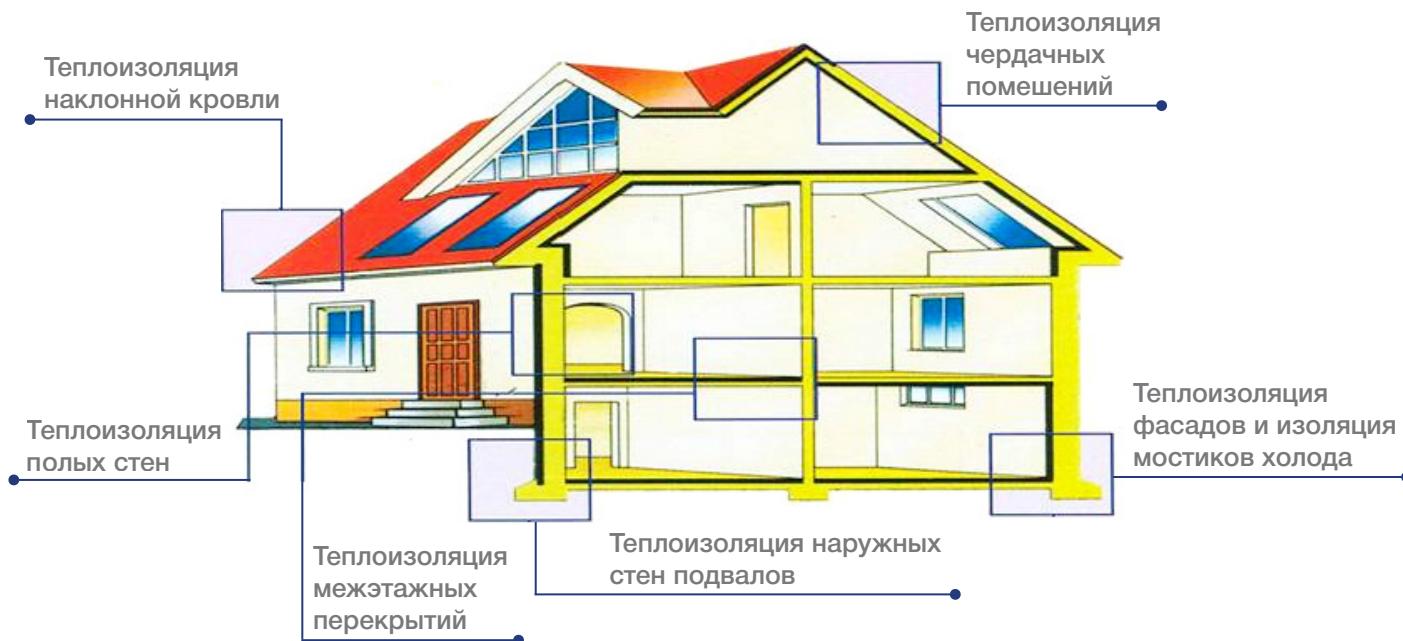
Схема теплоизоляции ограждающих конструкций жилого дома
